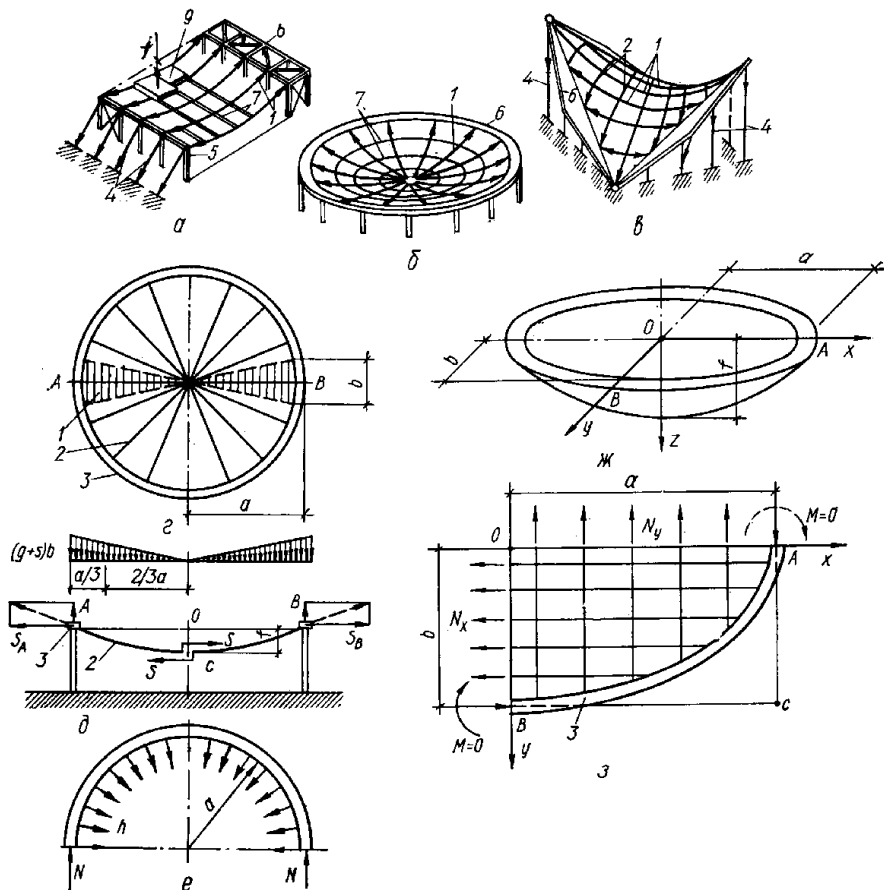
Вантові покриття: а – однопролітні системи вант на прямокутному плані; б – те ж, на круглому плані; в – те ж, гіперболічного контуру; г – до розрахунку круглого в плані покриття з радіально розташованими вантами; д – розрахункова схема; е – розрахункова схема опорного кільця; ж – до розрахунку еліптичного в плані покриття з ортогонально розташованими вантами; з – розрахункова схема; 1 – провислий вант; 2 – стабілізуючий вант; 3 – розпірка; 4 – відтяжка; 5 – колона; 6 – опорний контур; 7 – балки; 8 – залізобетонна чи армоцементна збірна плита
